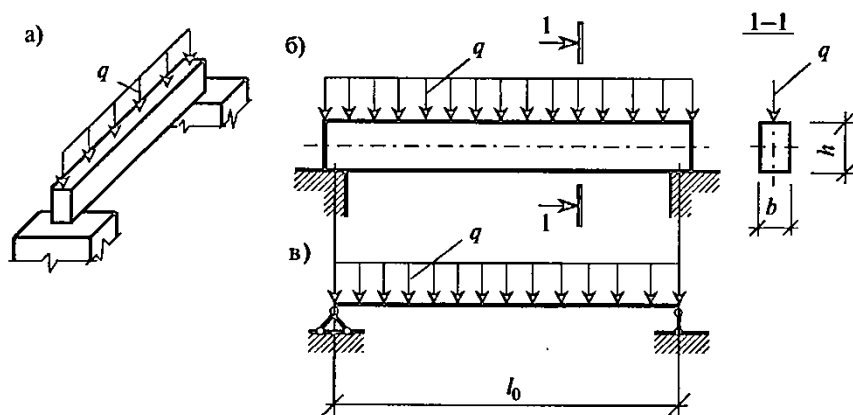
Прямой поперечный изгиб балки от равномерно распределенной нагрузки: а) аксонометрическая схема балки; б) конструктивная схема балки; в) расчетная схема балки
